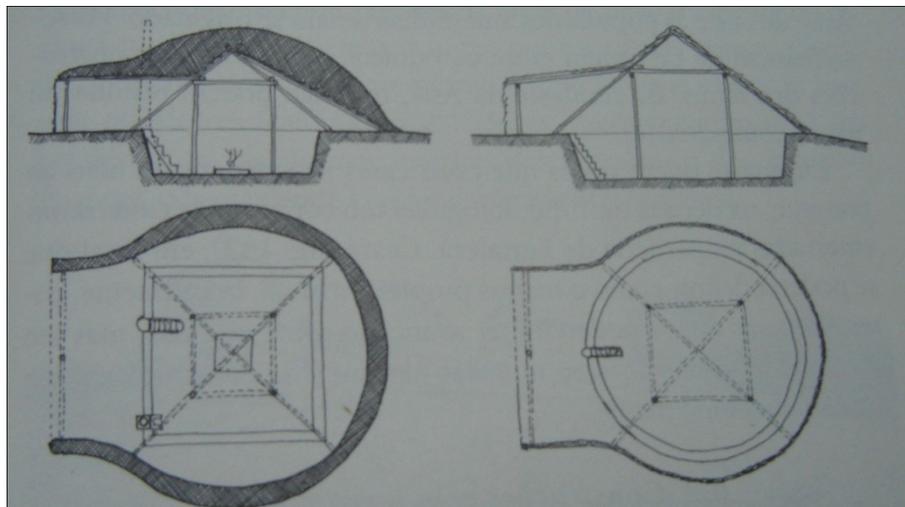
Nos esquemas à esquerda, corte e planta de construção recoberta com barro no noroeste da Ásia. Nos esquemas à direita, corte e planta de traçados semelhantes, porém com cobertura vegetal, no Brasil.
